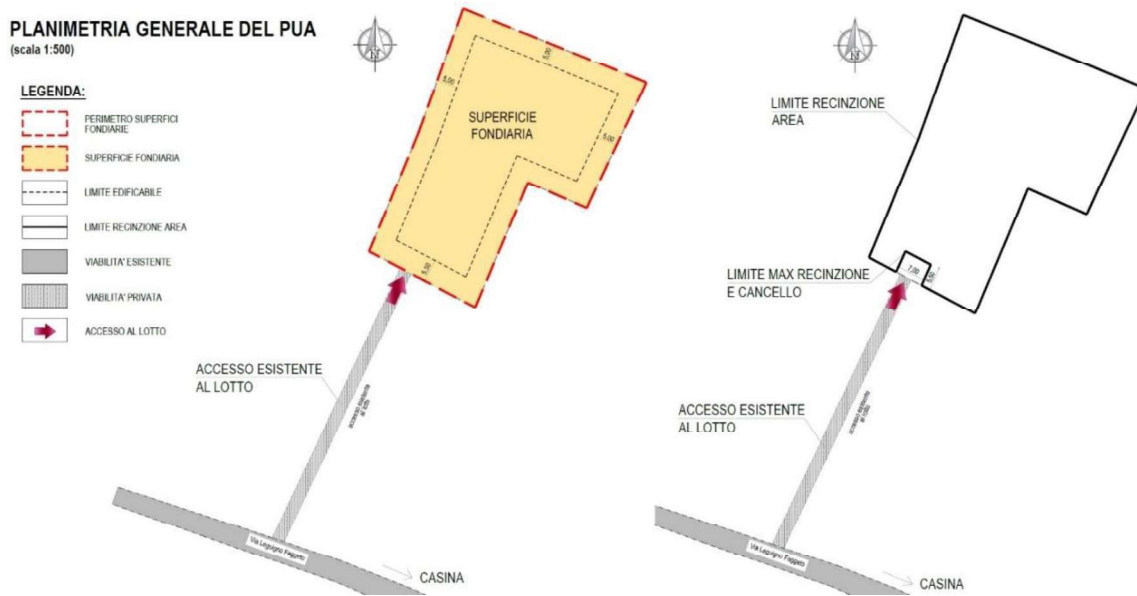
Planimetria generale con sistemazione interna del lotto edificabile (proposta non vincolante)
